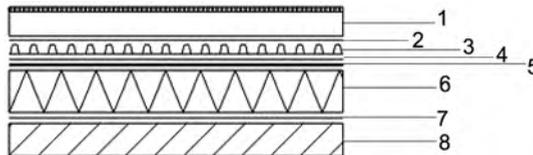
Инверсионная зеленая кровля: 1 — почвенный слой; 2 — геотекстиль; 3 — дренажное полотно Максдрейн; 4 — геотекстиль; 5 — теплоизоляция; 6 — мембрана Преласты (1,5 мм); 7 — геотекстиль; 8 — бетонная плита
